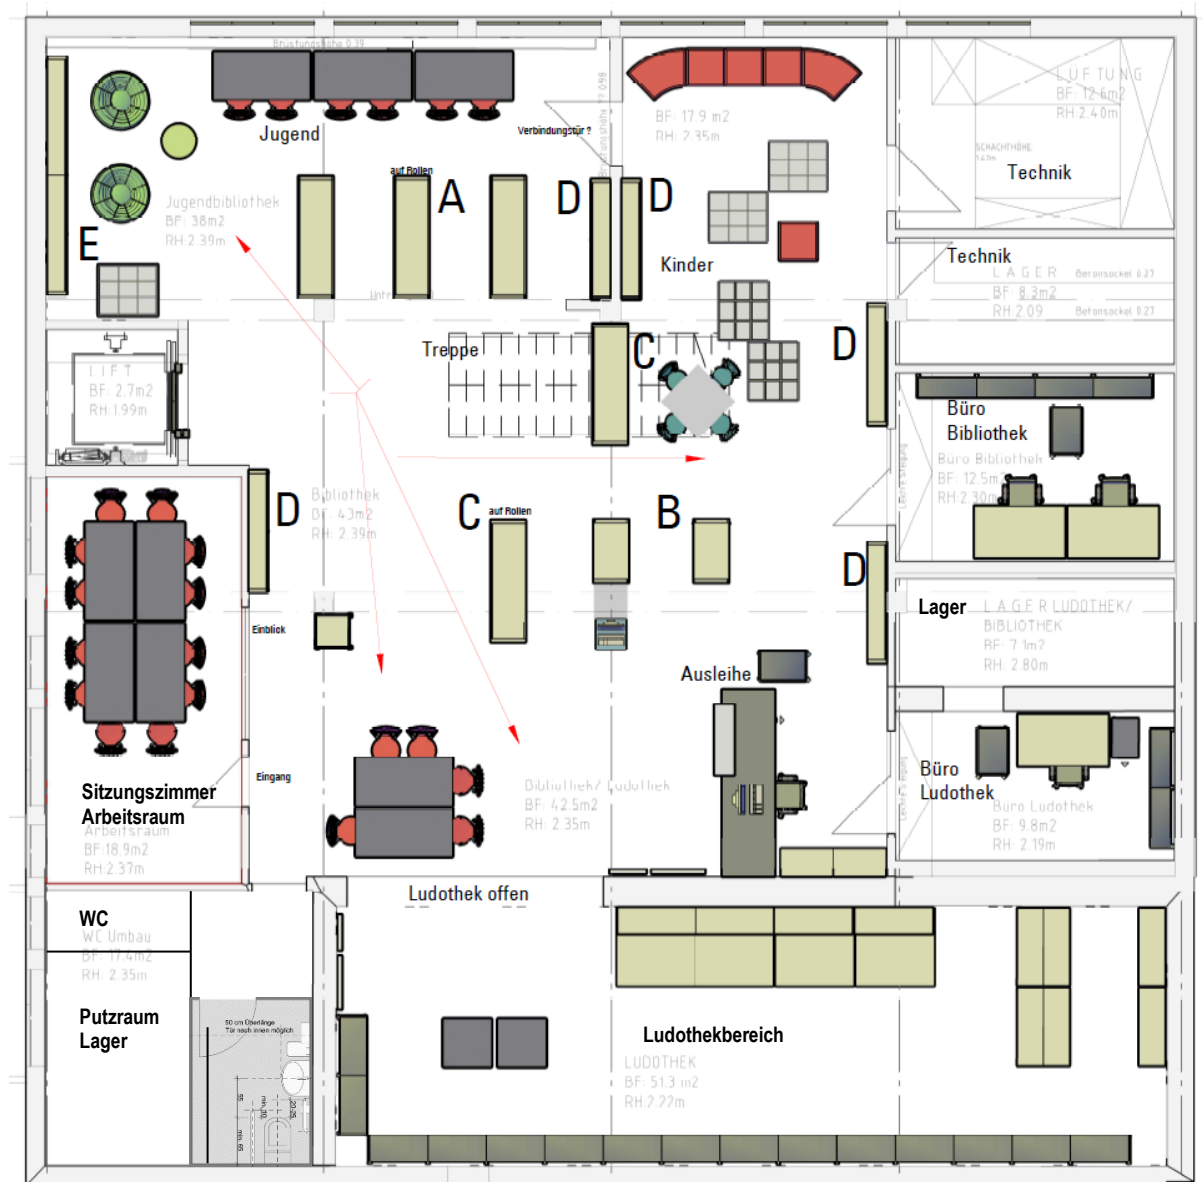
Grundriss Untergeschoss Bernstrasse 72 – mit möglicher Einteilung und Möblierung (Vorprojekt)
